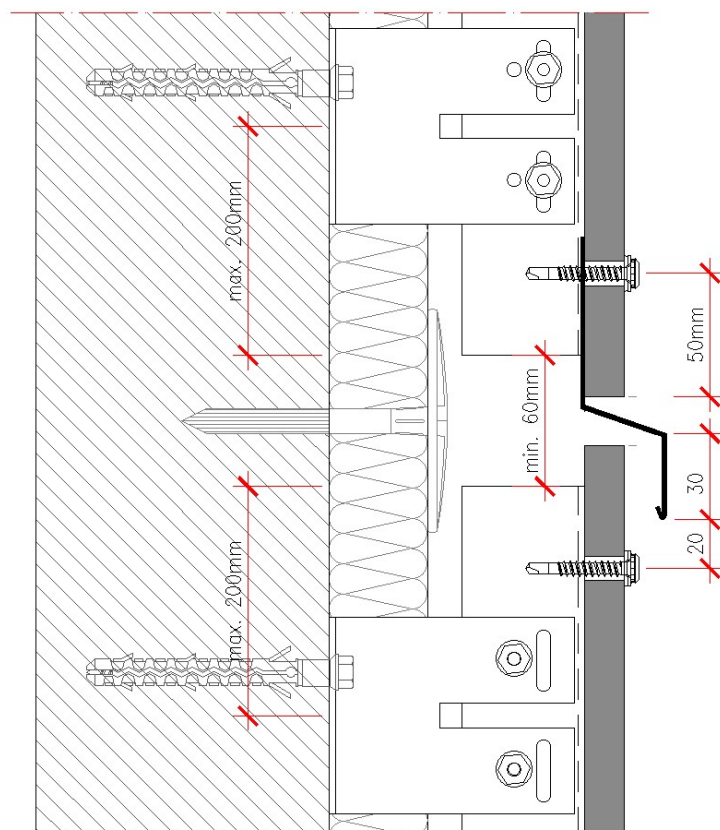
Fracionamento da estrutura: Perfis com comprimento  $> 6$  m
